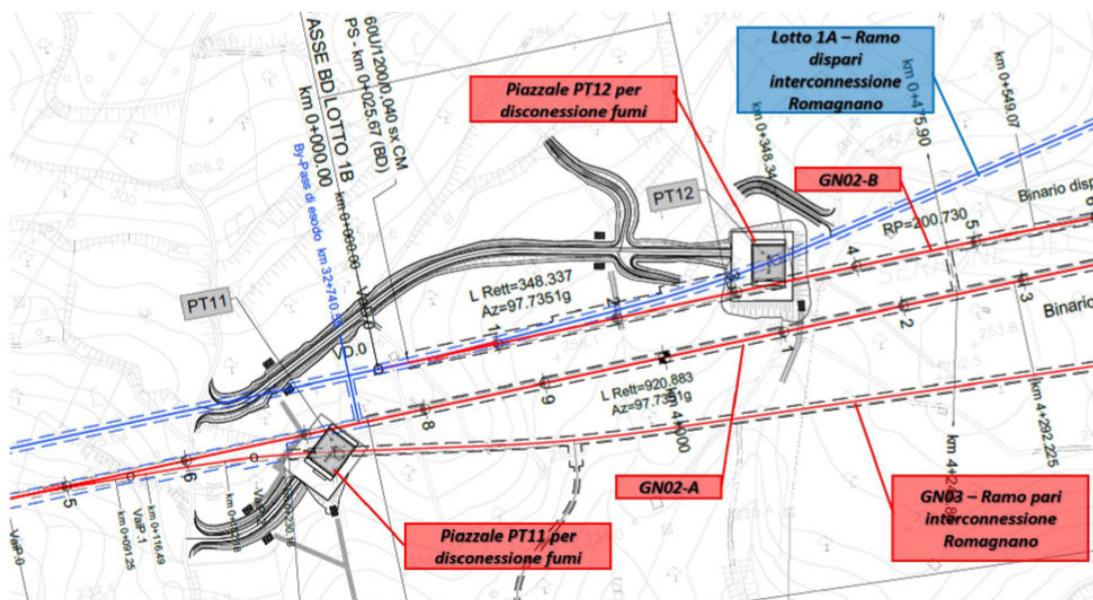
Stralcio planimetrico con individuazione piazzali disconnessione fumi
